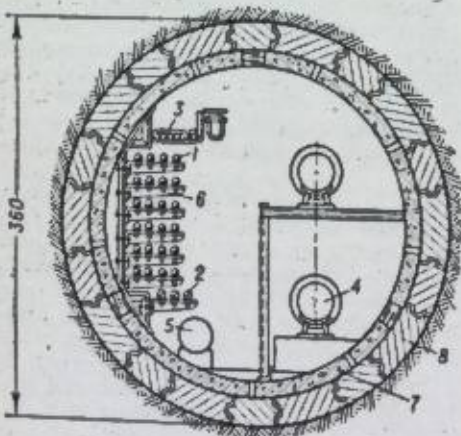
Коллекторный туннель: 1 — кабели силовые; 2 — кабели связи; 3 — кабели внутреннего обслуживания; 4 — трубы теплосети; 5 — трубы водопровода; 6 — металлические полочки; 7 — сборная железобетонная обделка; 8 — сборная железобетонная обделка.
